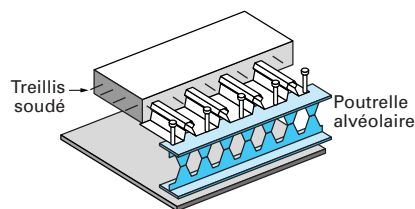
Poutrelle ajourée à nid-d'abeilles ou à ouvertures hexagonales
